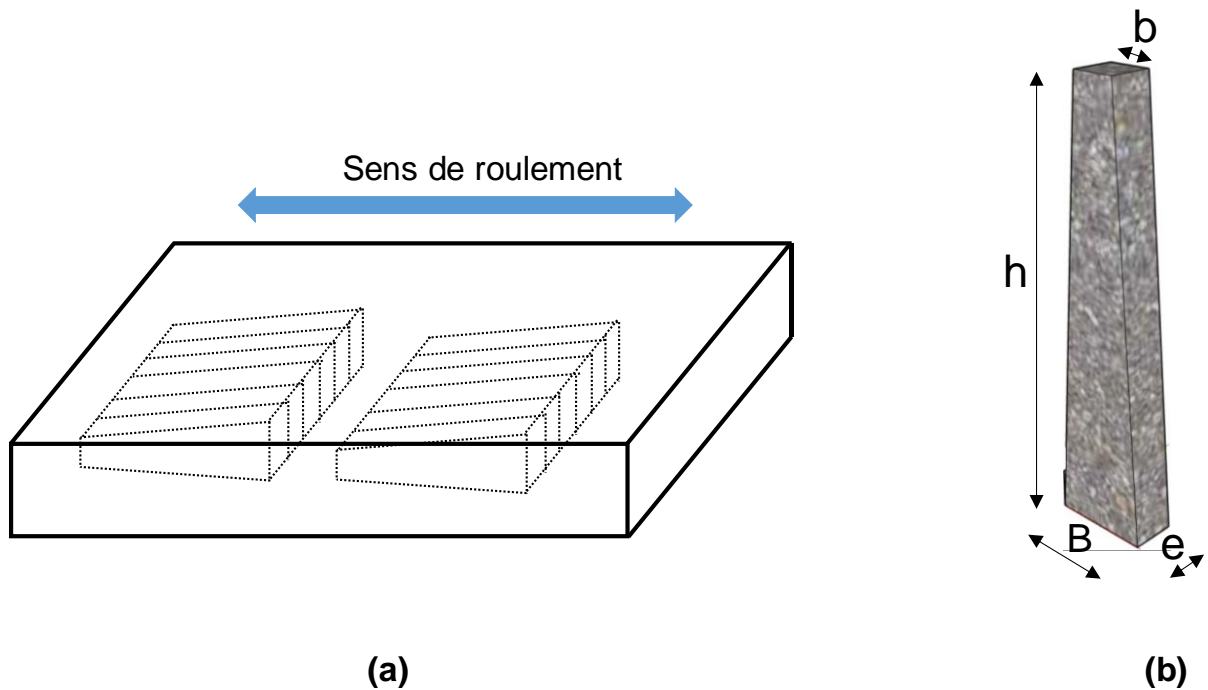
(a) Schéma de débitage des éprouvettes dans les plaques (b) Dimension de l'éprouvette trapézoïdale
